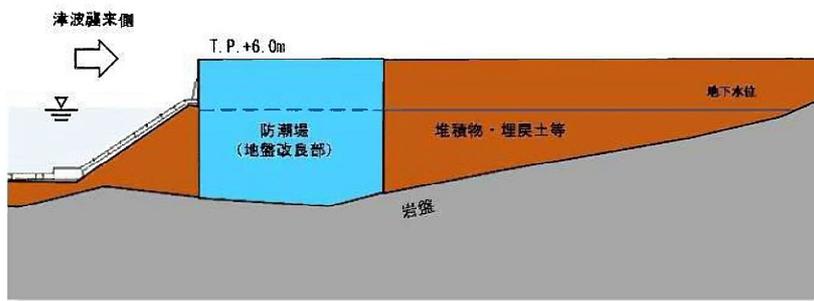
地盤改良部 断面図 (C-C 断面)
